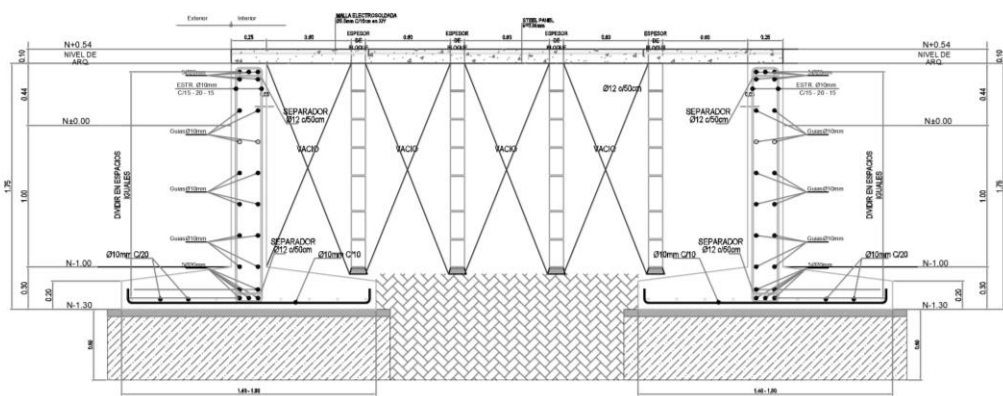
Corte transversal de cimentación y paredes de bloques y vacíos OM Center.
